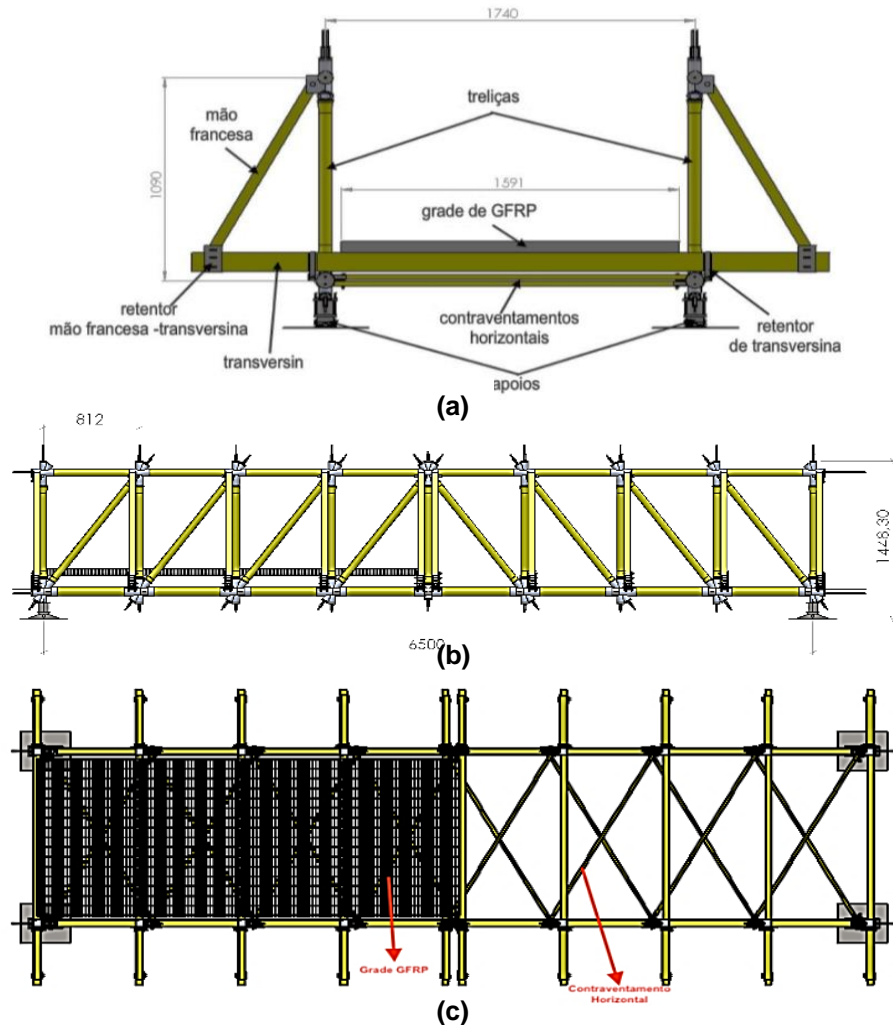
Ponte do modelo reduzido: (a) seção transversal, (b) vista lateral e (c) vista superior da ponte. (dimensões em mm)
